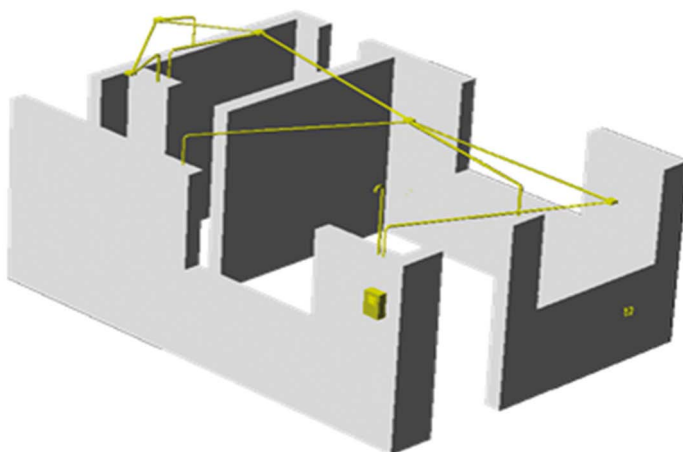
Instalación eléctrica de obra arquitectónica simple
